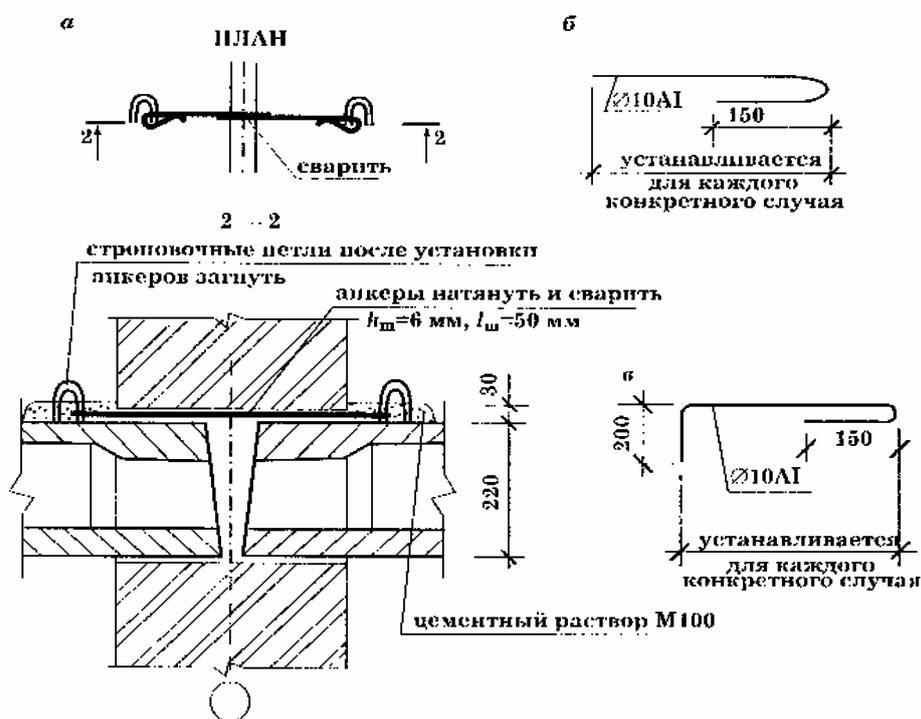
Анкеровка плит перекрытий арматурными стержнями:
